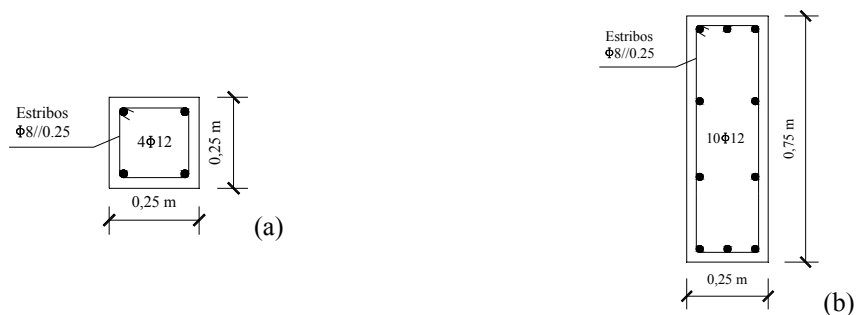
Pilares: (a) secção tipo dos pilares quadrados (C1-5; C7-9); (b) secção do pilar rectangular (C6).
